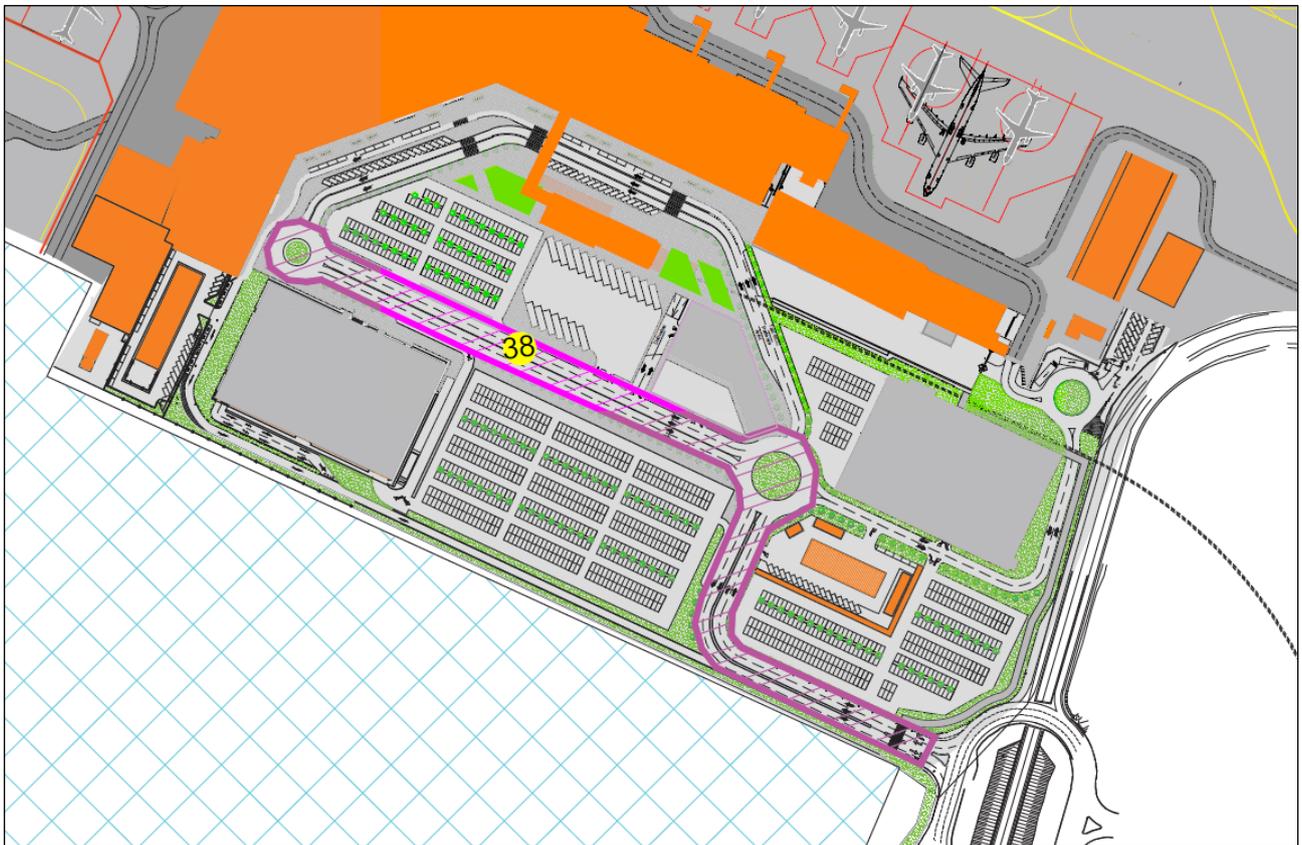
Estratto Master Plan – Nuova Viabilità Landside
